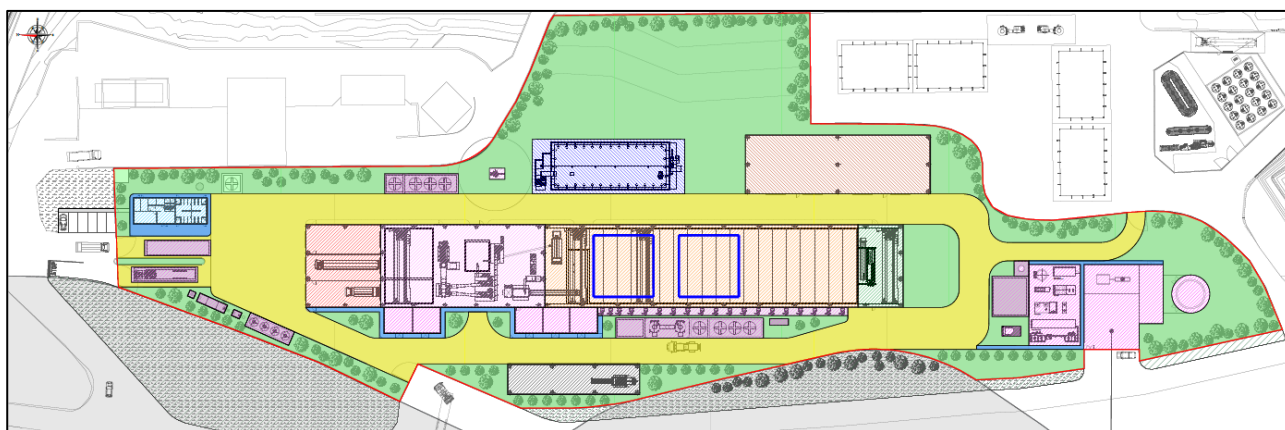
Stralcio tavola T20 – Planimetria superfici
